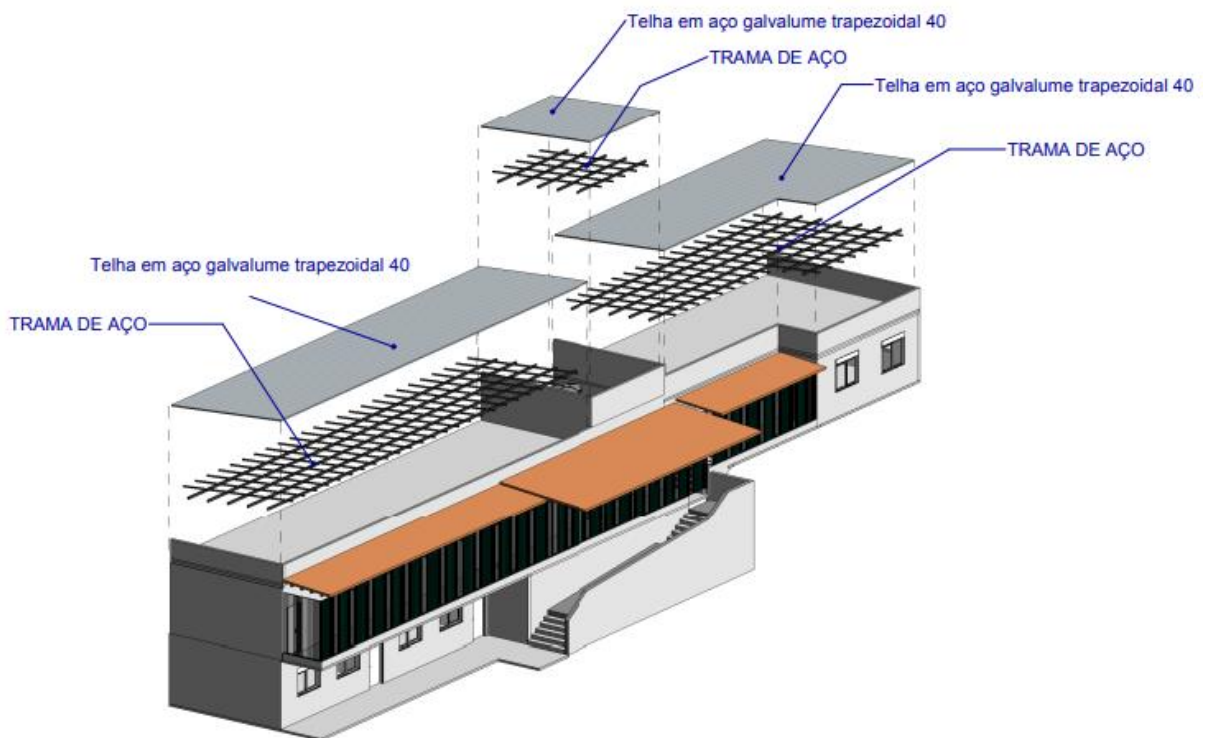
Ex. do arranjo da cobertura metálica (bloco nº 05)
